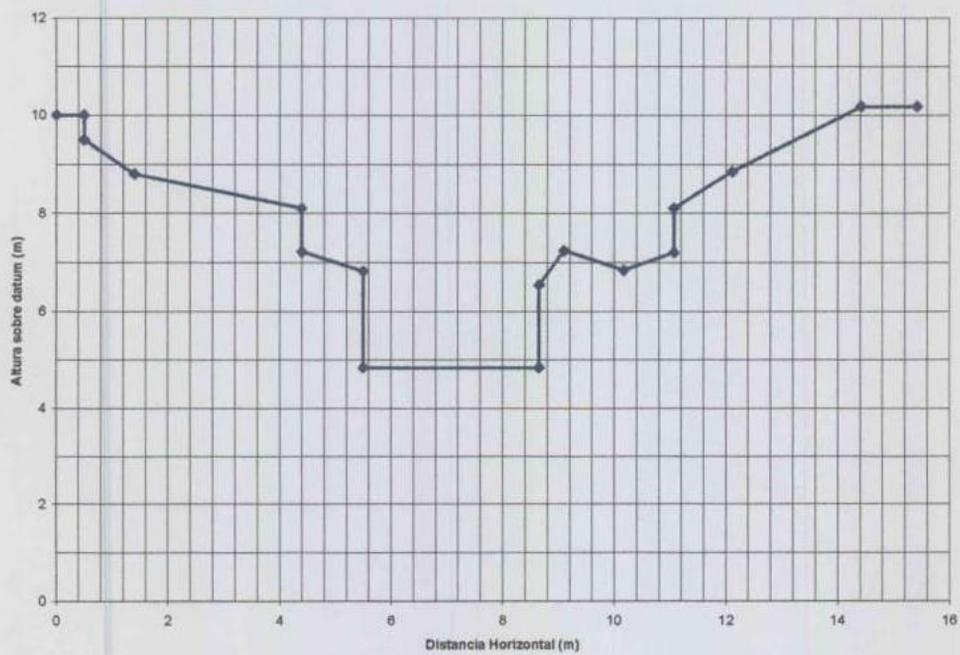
Sección hidráulica de la cárcava para la construcción de la presa de llantas.
